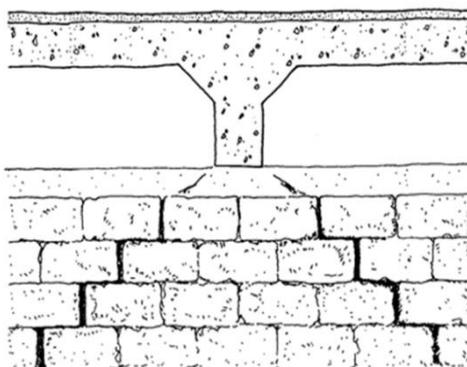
FIS-10 Descripción: Fisuración o agrietamiento en cabeza de pila o estribo bajo apoyo de tableros.
